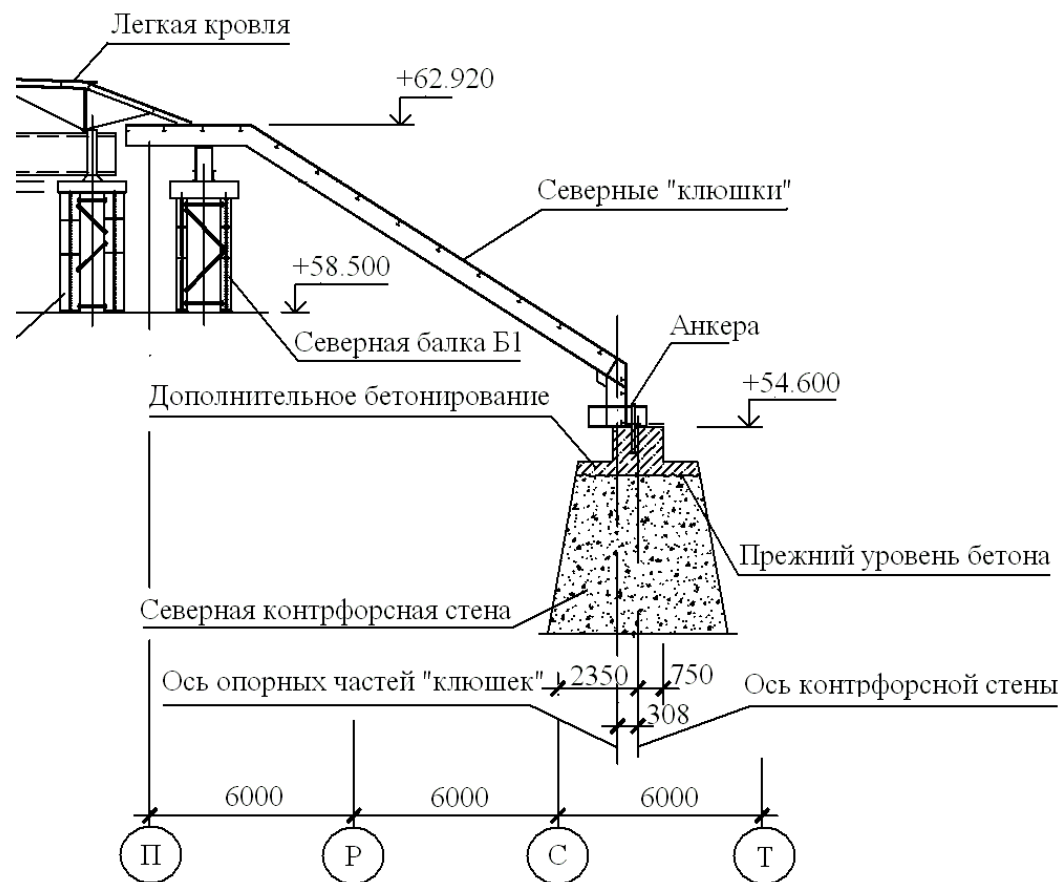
Схема установки наружных анкеров северных щитов-«клюшек» и добетонирования контрфорсной стены.
